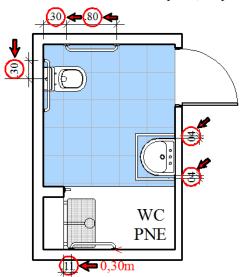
Planta Baixa de WC da UHA (Dimensões do banco articulado removível)
